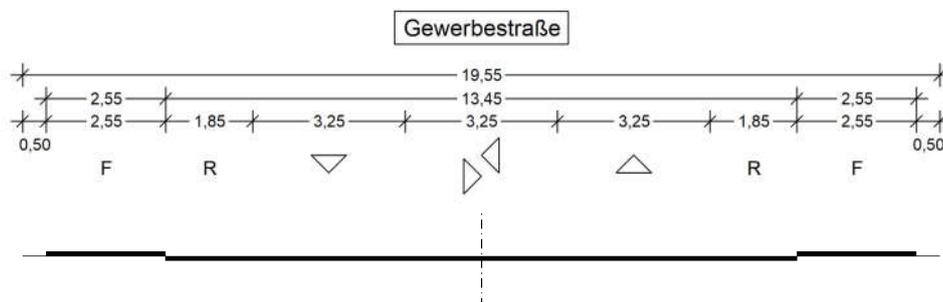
Querschnitt Entwurfsbild „Gewerbestraße“
